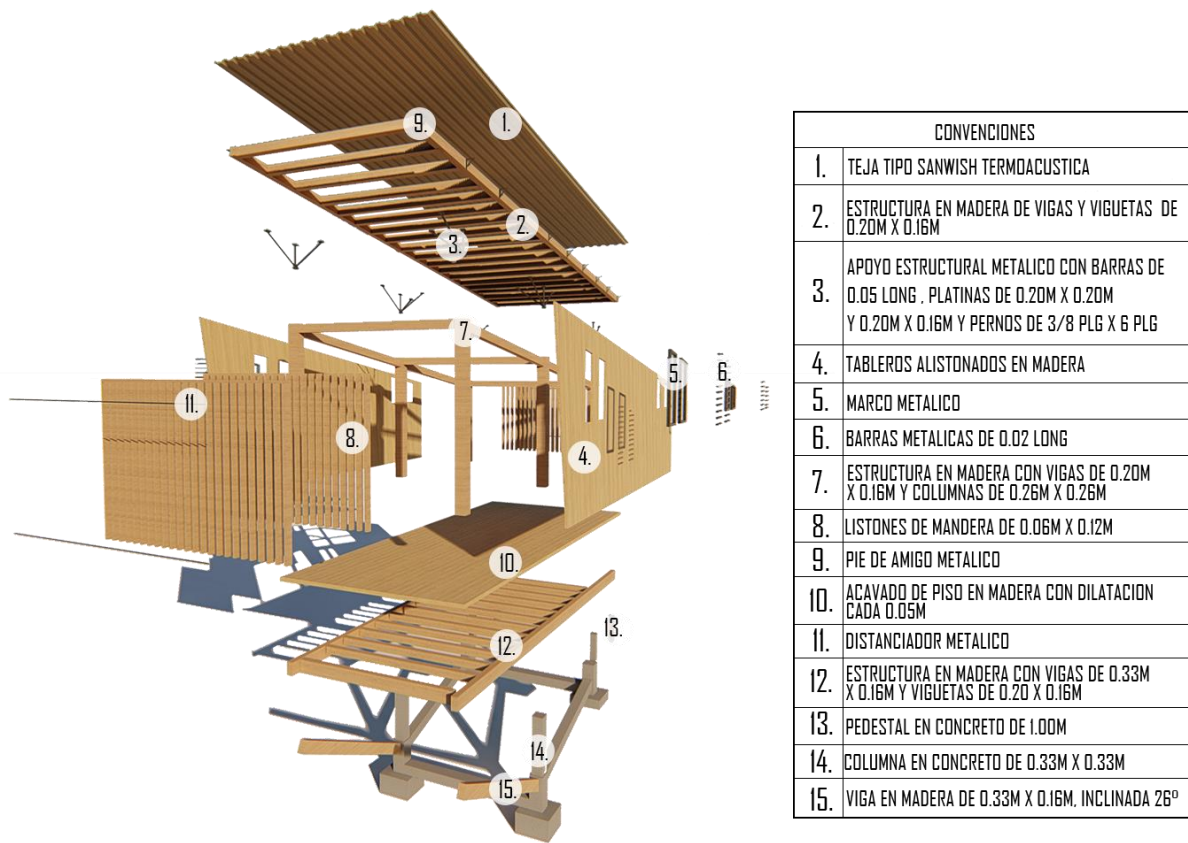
Explotado con características constructivas tipo. Elaboración propia.
